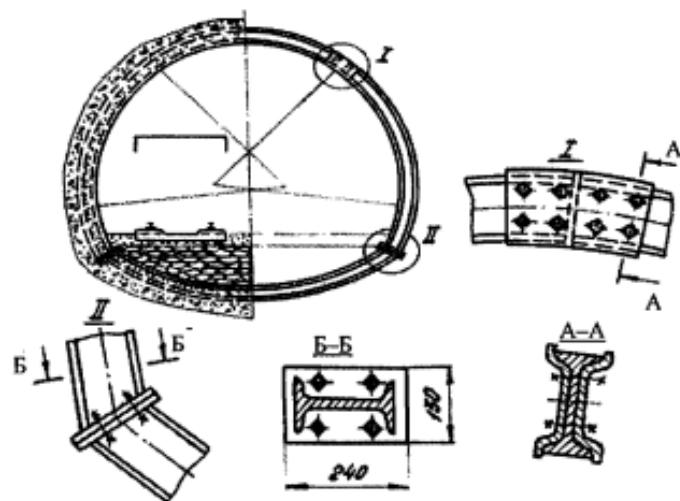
Замкнутая железобетонная крепь с жесткой арматурой
